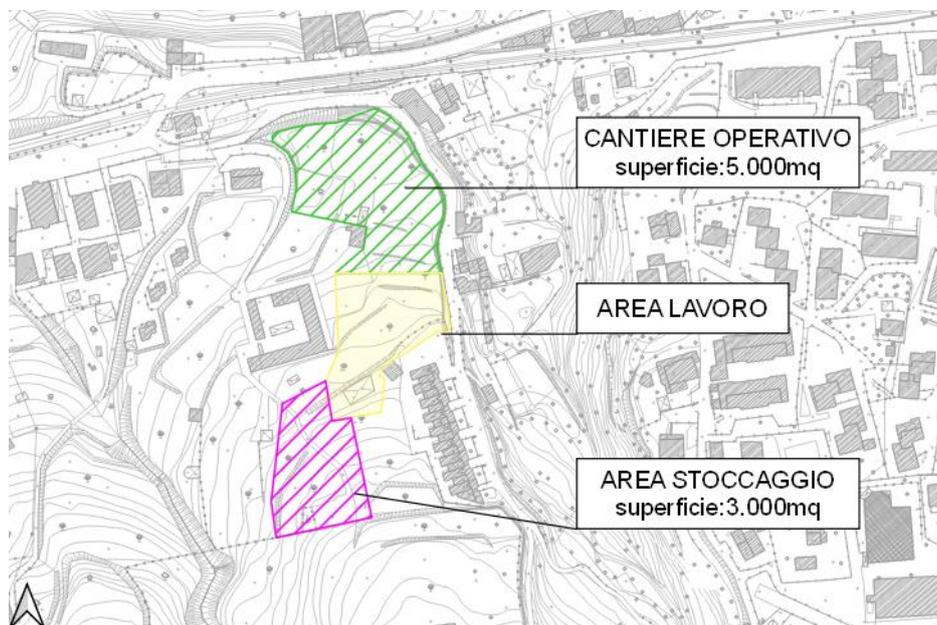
Planimetria dei cantieri- NS elaborazione GIS ed Autocad
